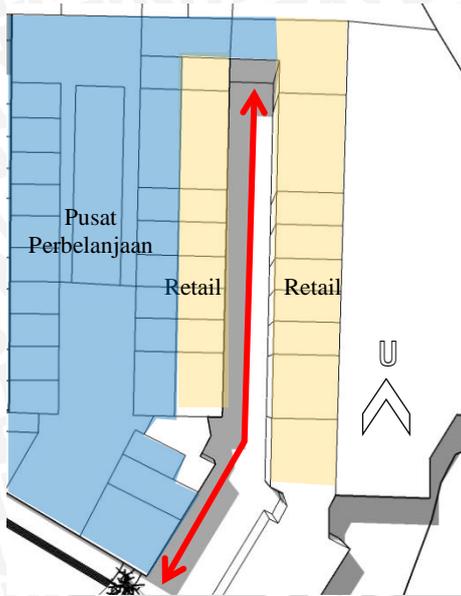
Skematik Melewati Ruang dan Berakhir dalam Ruang Pada Koridor *Young Street
